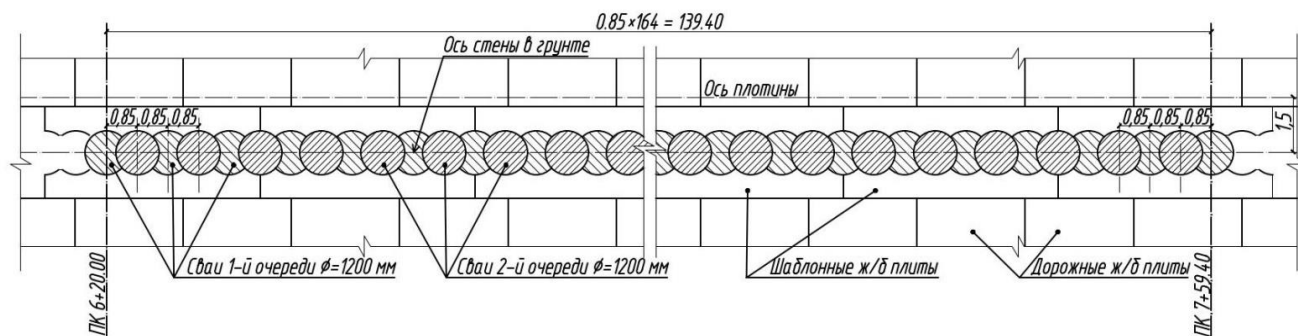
Расположение свай стены в грунте на гребне плотины
